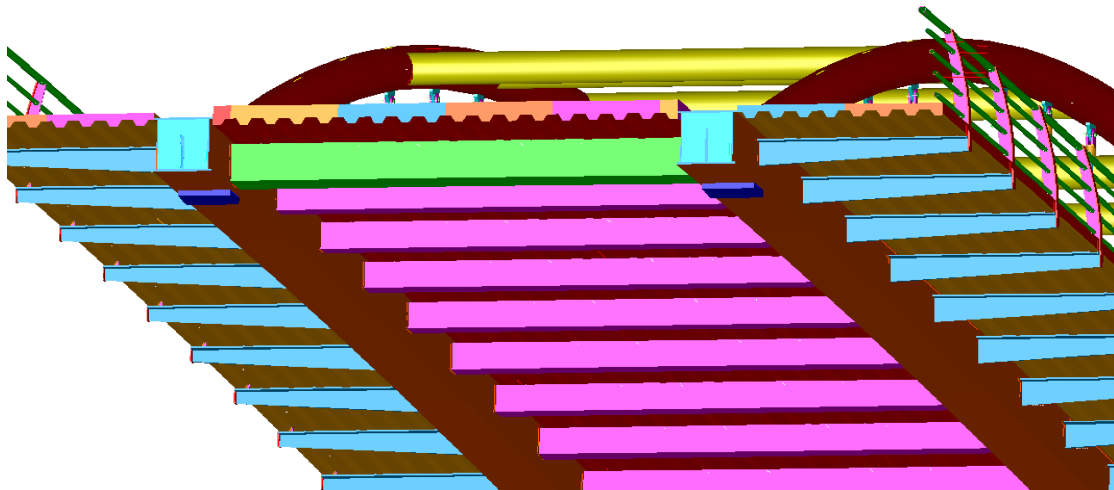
Vigas cajón, con vigas metálicas transversales soportando el peso de la calzada
